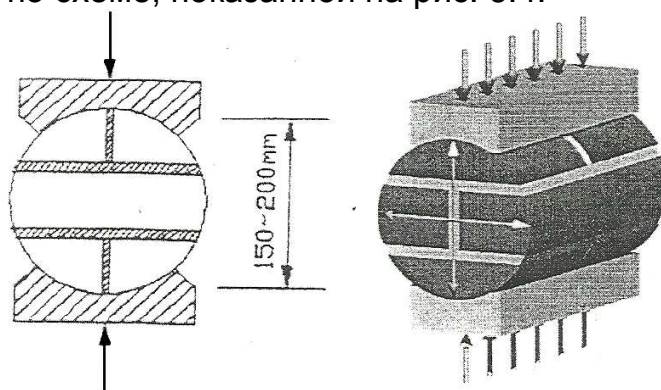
Схема испытаний образцов кладки на сжатие
